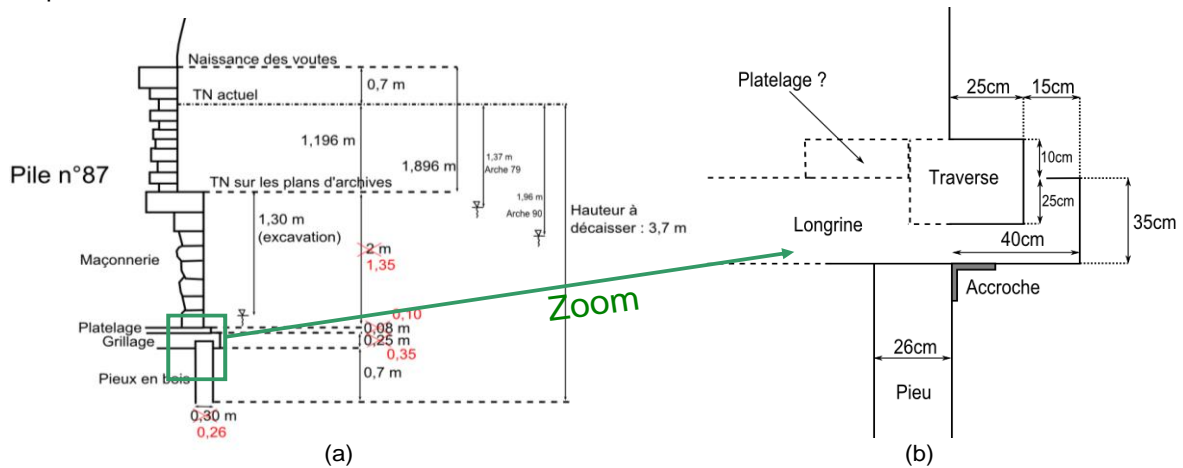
Coupe de terrain au droit de la pile n°87 (a) et zoom sur le platelage, le grillage et les pieux (b)
